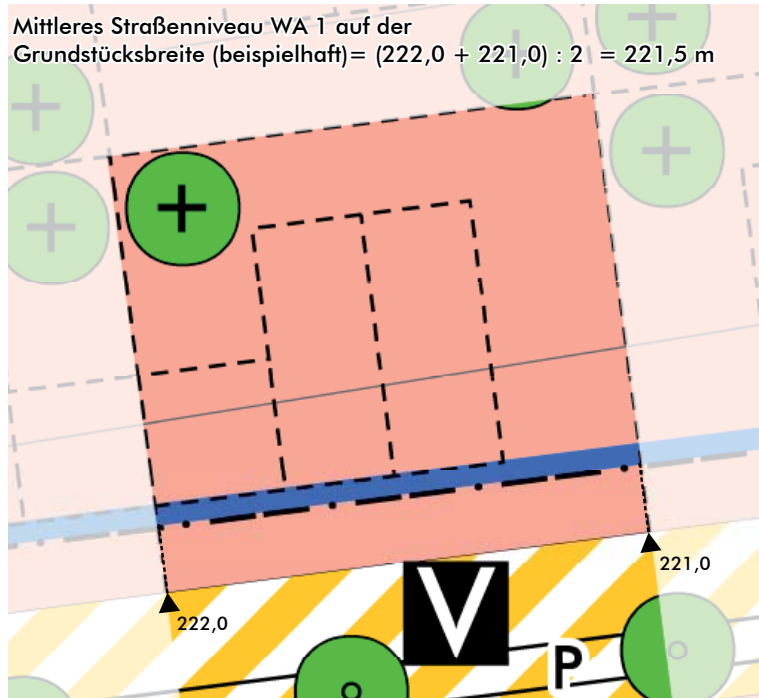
Schemagrundriss Unterer Bezugspunkt WH und GH im WA 1, unmaßstäblich
